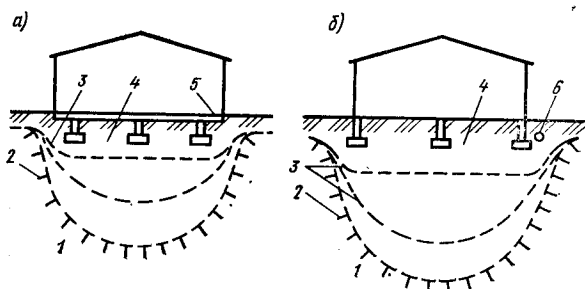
Схема регулирования процесса оттаивания грунтов основания:
